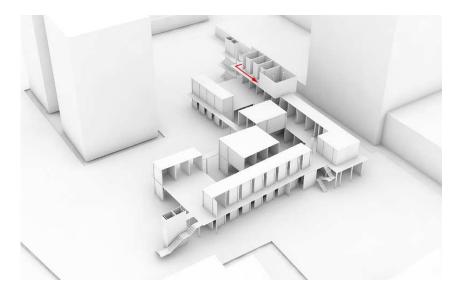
Direccionamiento de circulaciones internas en segunda planta alta.
